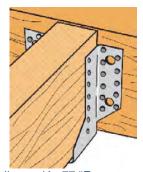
"Estructura de madera". Fuente: www.systemed.fr/forumbricolage/realisation
